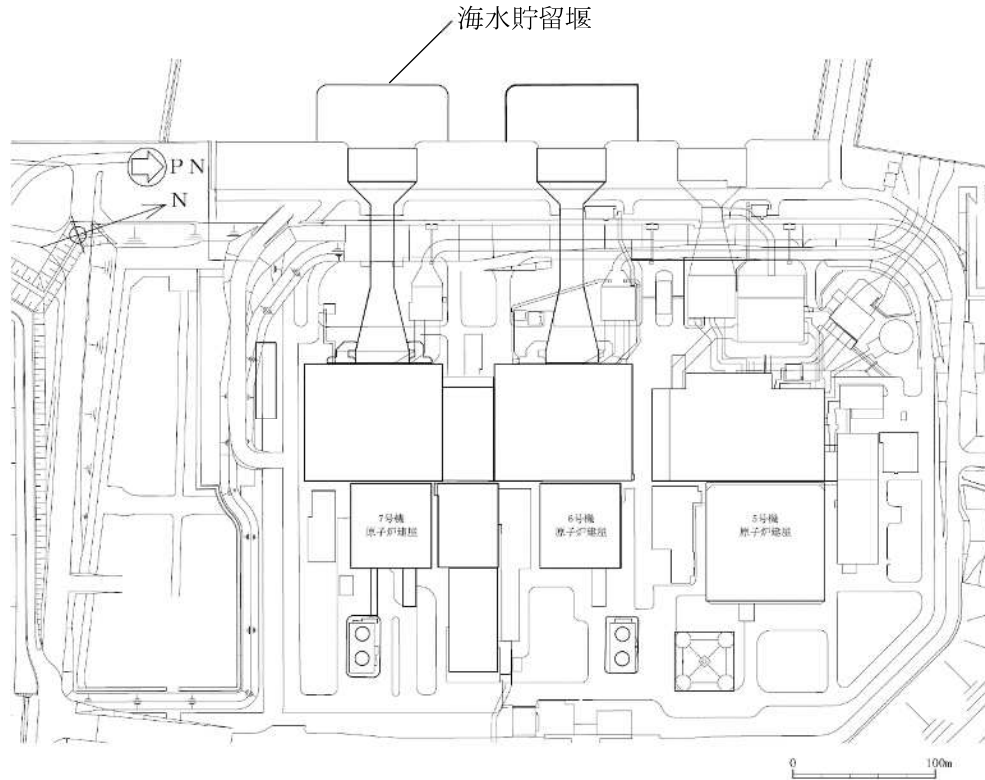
(1) 海水貯留堰の位置図（全体平面図）
